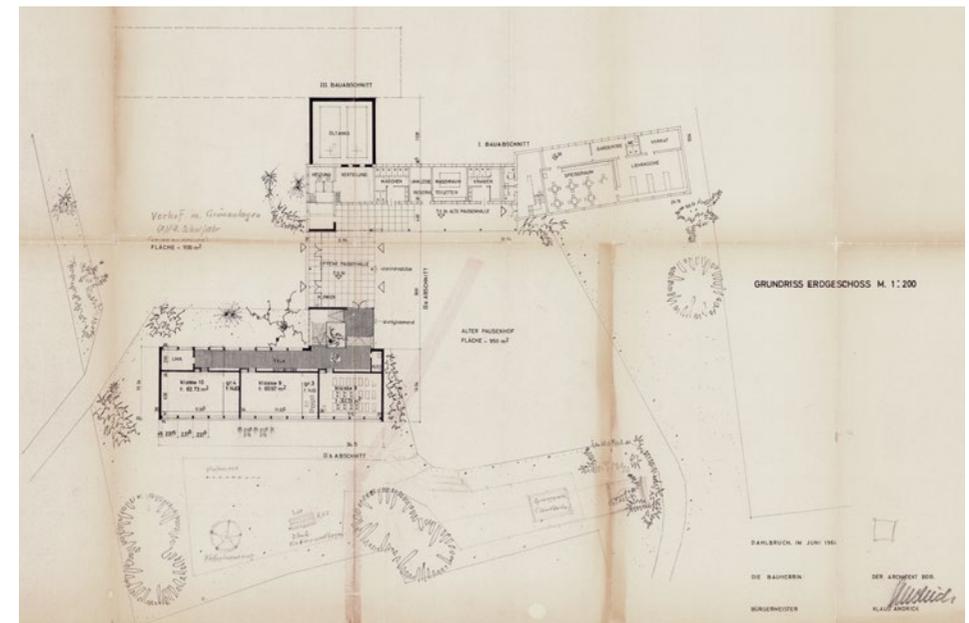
Zweiter Bauabschnitt des Schulneubaus an der Hochstraße, Grundrissplan, Klaus Andrick, Juni 1964
